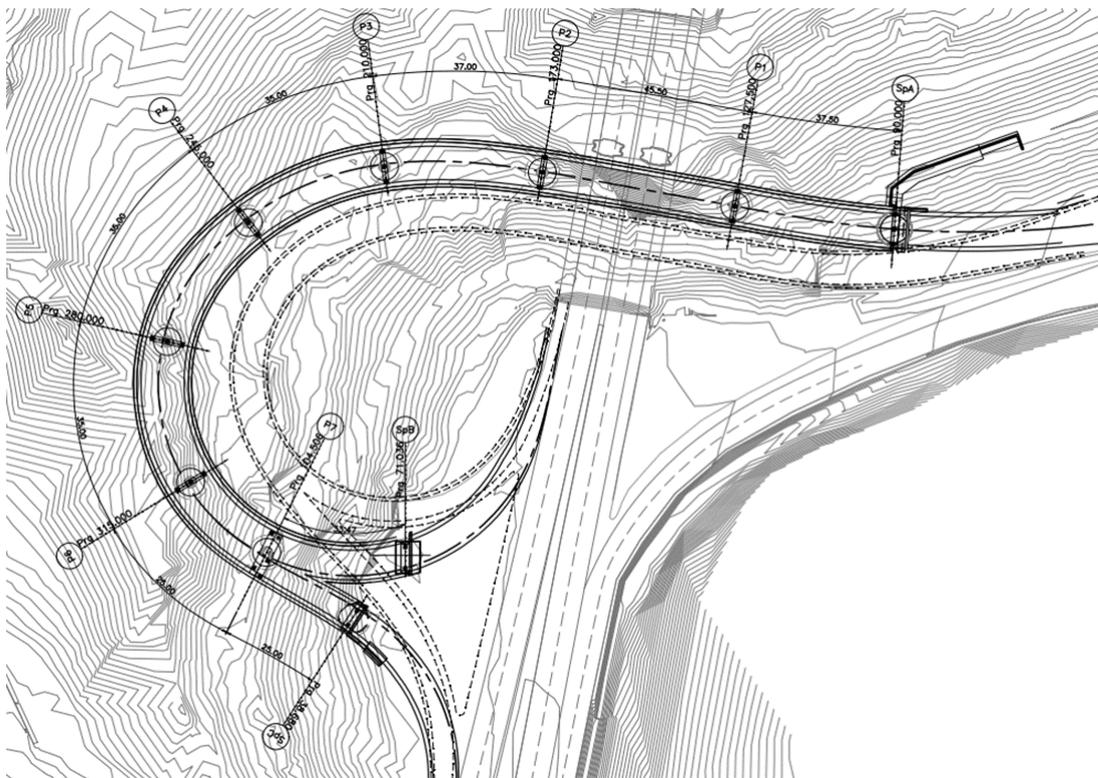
Planimetria del nuovo viadotto Tornimparte
